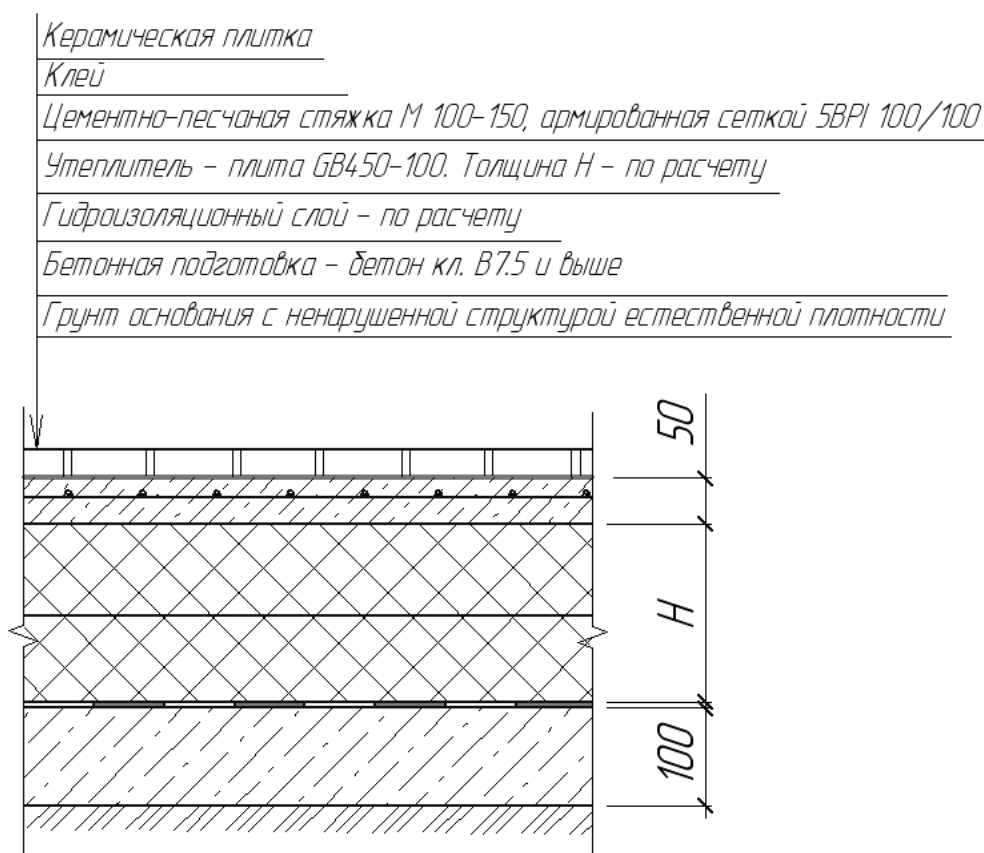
Конструкция плиточного пола по грунту с утеплением с применением системы плит GREEN BOARD®
